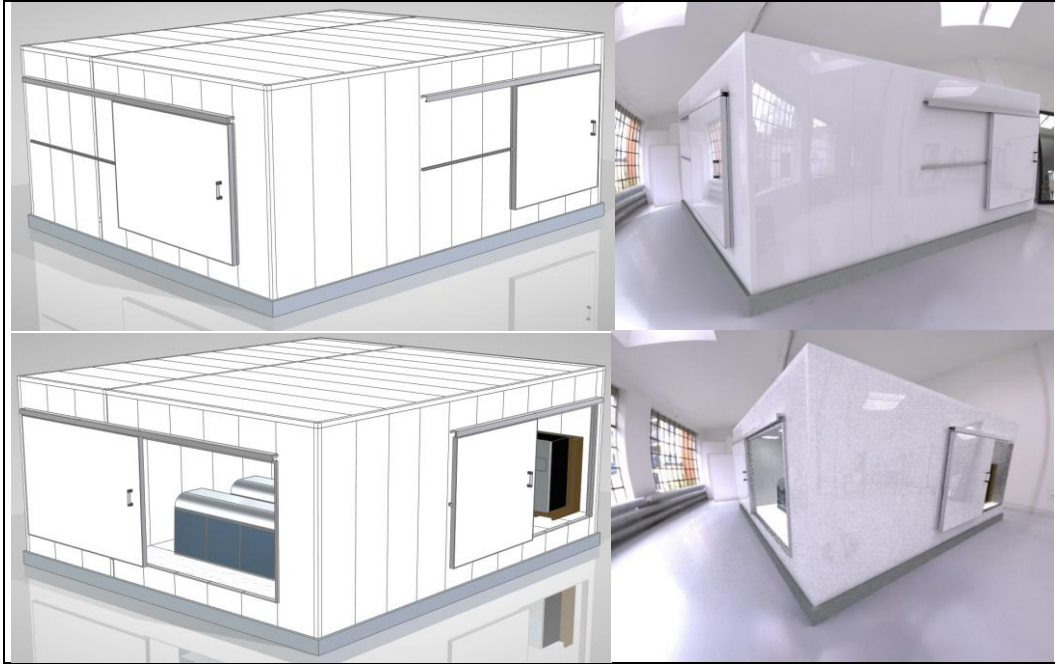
Sistema de armado y unión entre los paneles de aislamiento y la estructura de la cámara.
